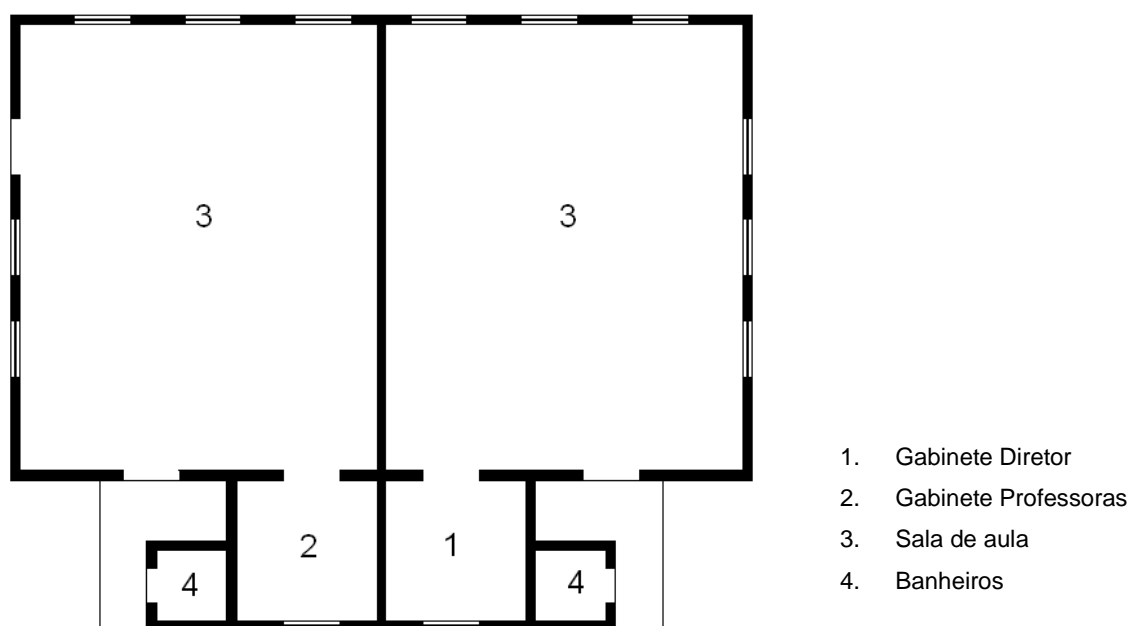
PLANTA COM DUAS SALAS DE AULA
